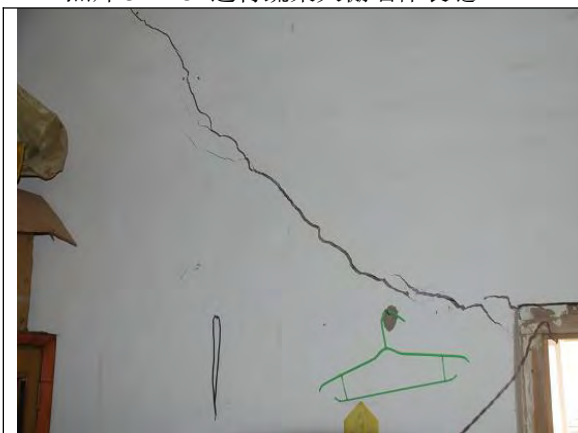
品悦饭店内墙体裂缝
